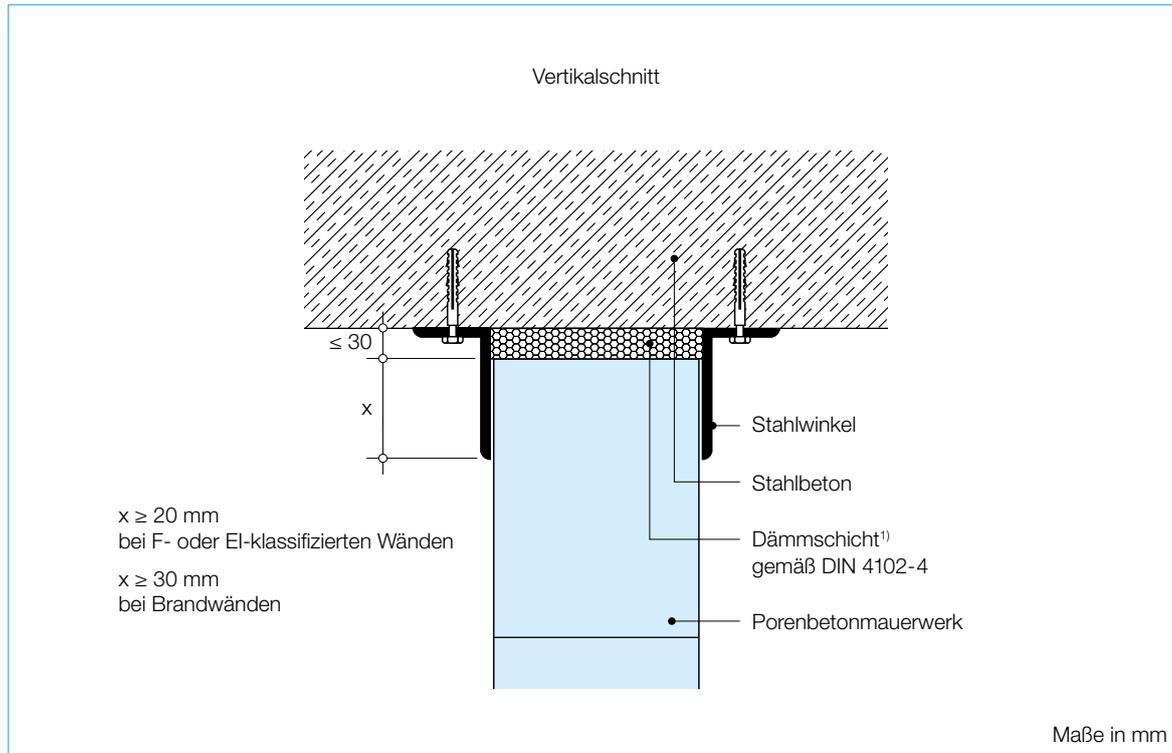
Brandschutztechnischer Anschluss einer nicht tragenden Wand aus Porenbetonmauerwerk an eine Stahlbetondecke
